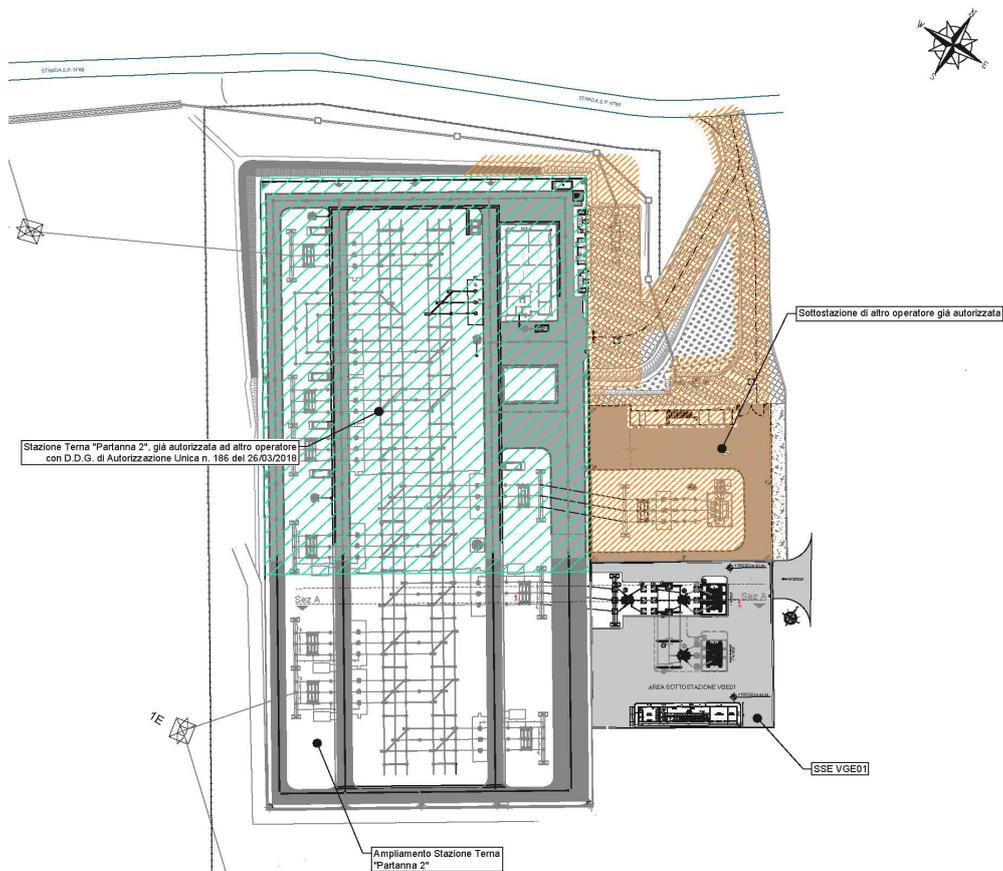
Planimetria Ampliamento Stazione Terna “Partanna 2” e Stazione produttore condivisa
